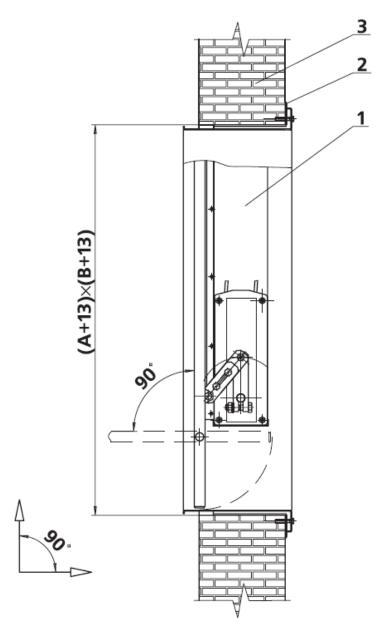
Монтаж дымового клапана КПД-4 производства ООО «Веза», присоединяемого к стене с использованием монтажной рамы: 1- клапан; 2- монтажная рама (мрз); 3- стена
